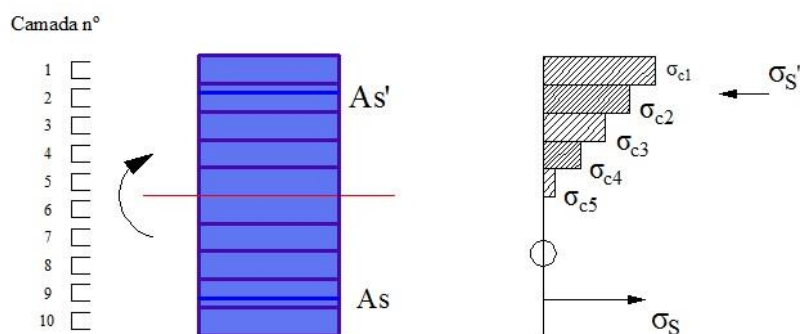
Distribuição de tensões numa secção fendilhada de betão armado no SAP2000
